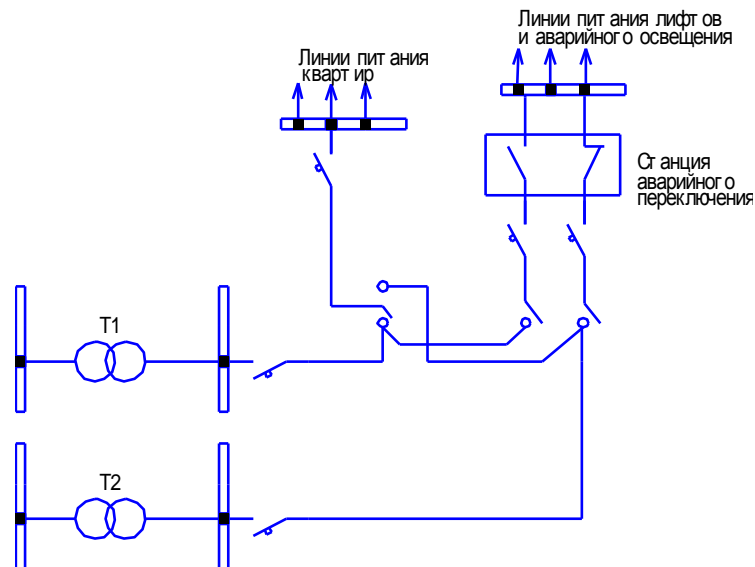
схема электроснабжения жилого дома высотой 17 этажей и более
